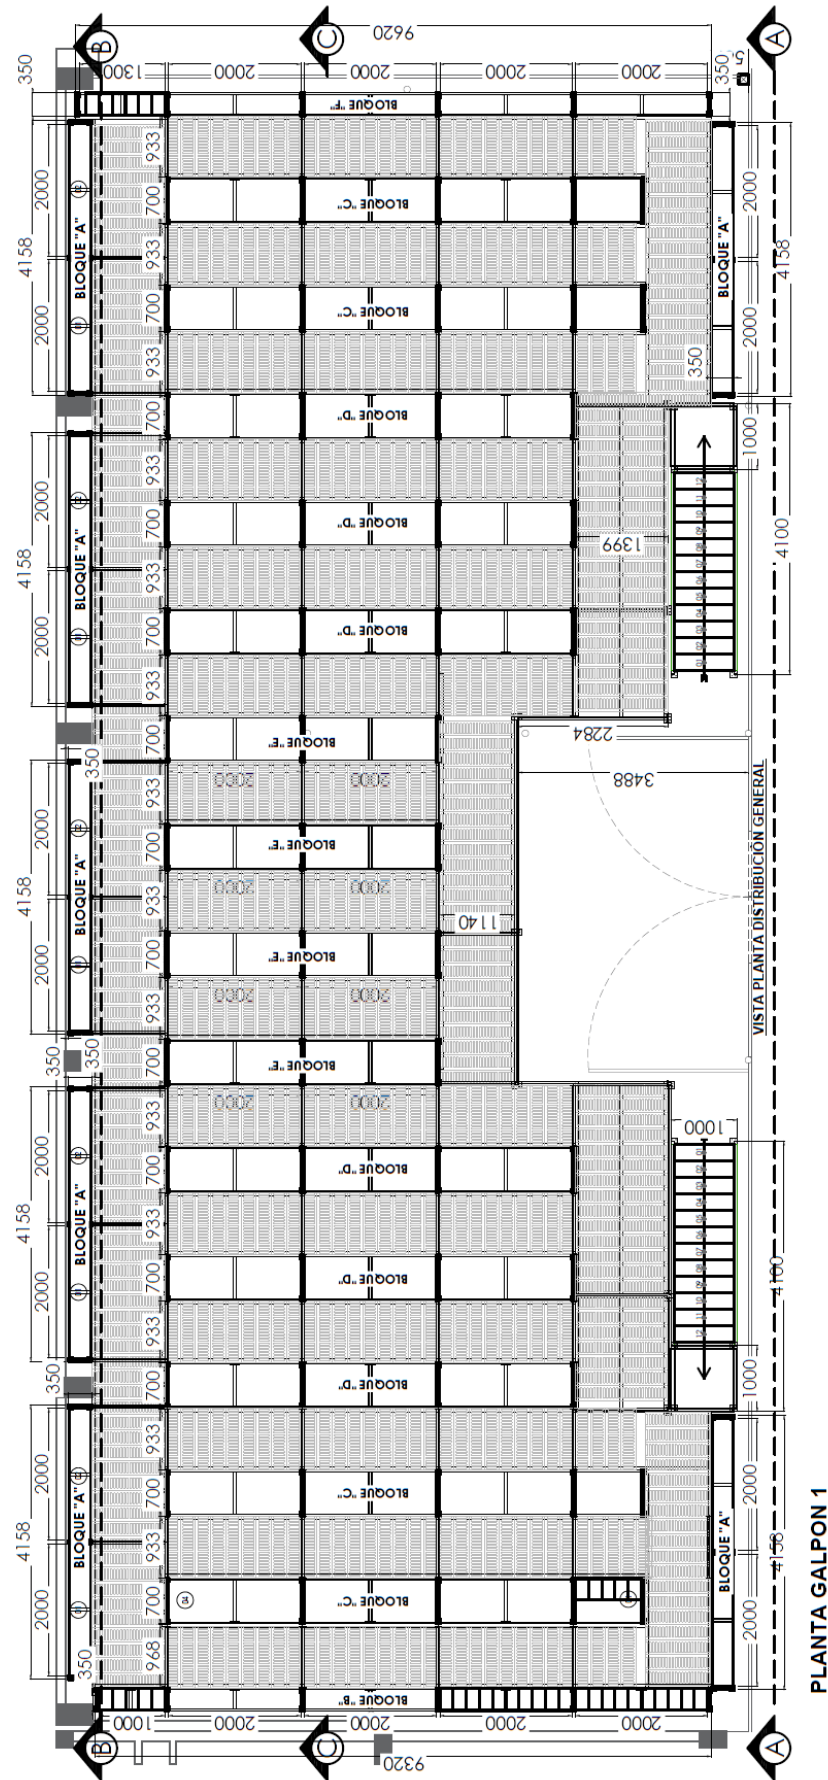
PLANTA GALPON 1 ESTADO ACTUAL
